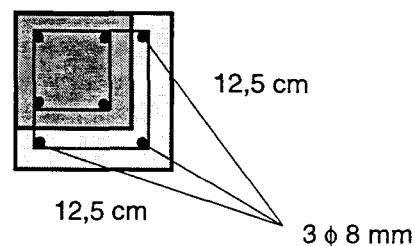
Seções transversais de concreto e armaduras dos pilares reforçados com concreto armado.
